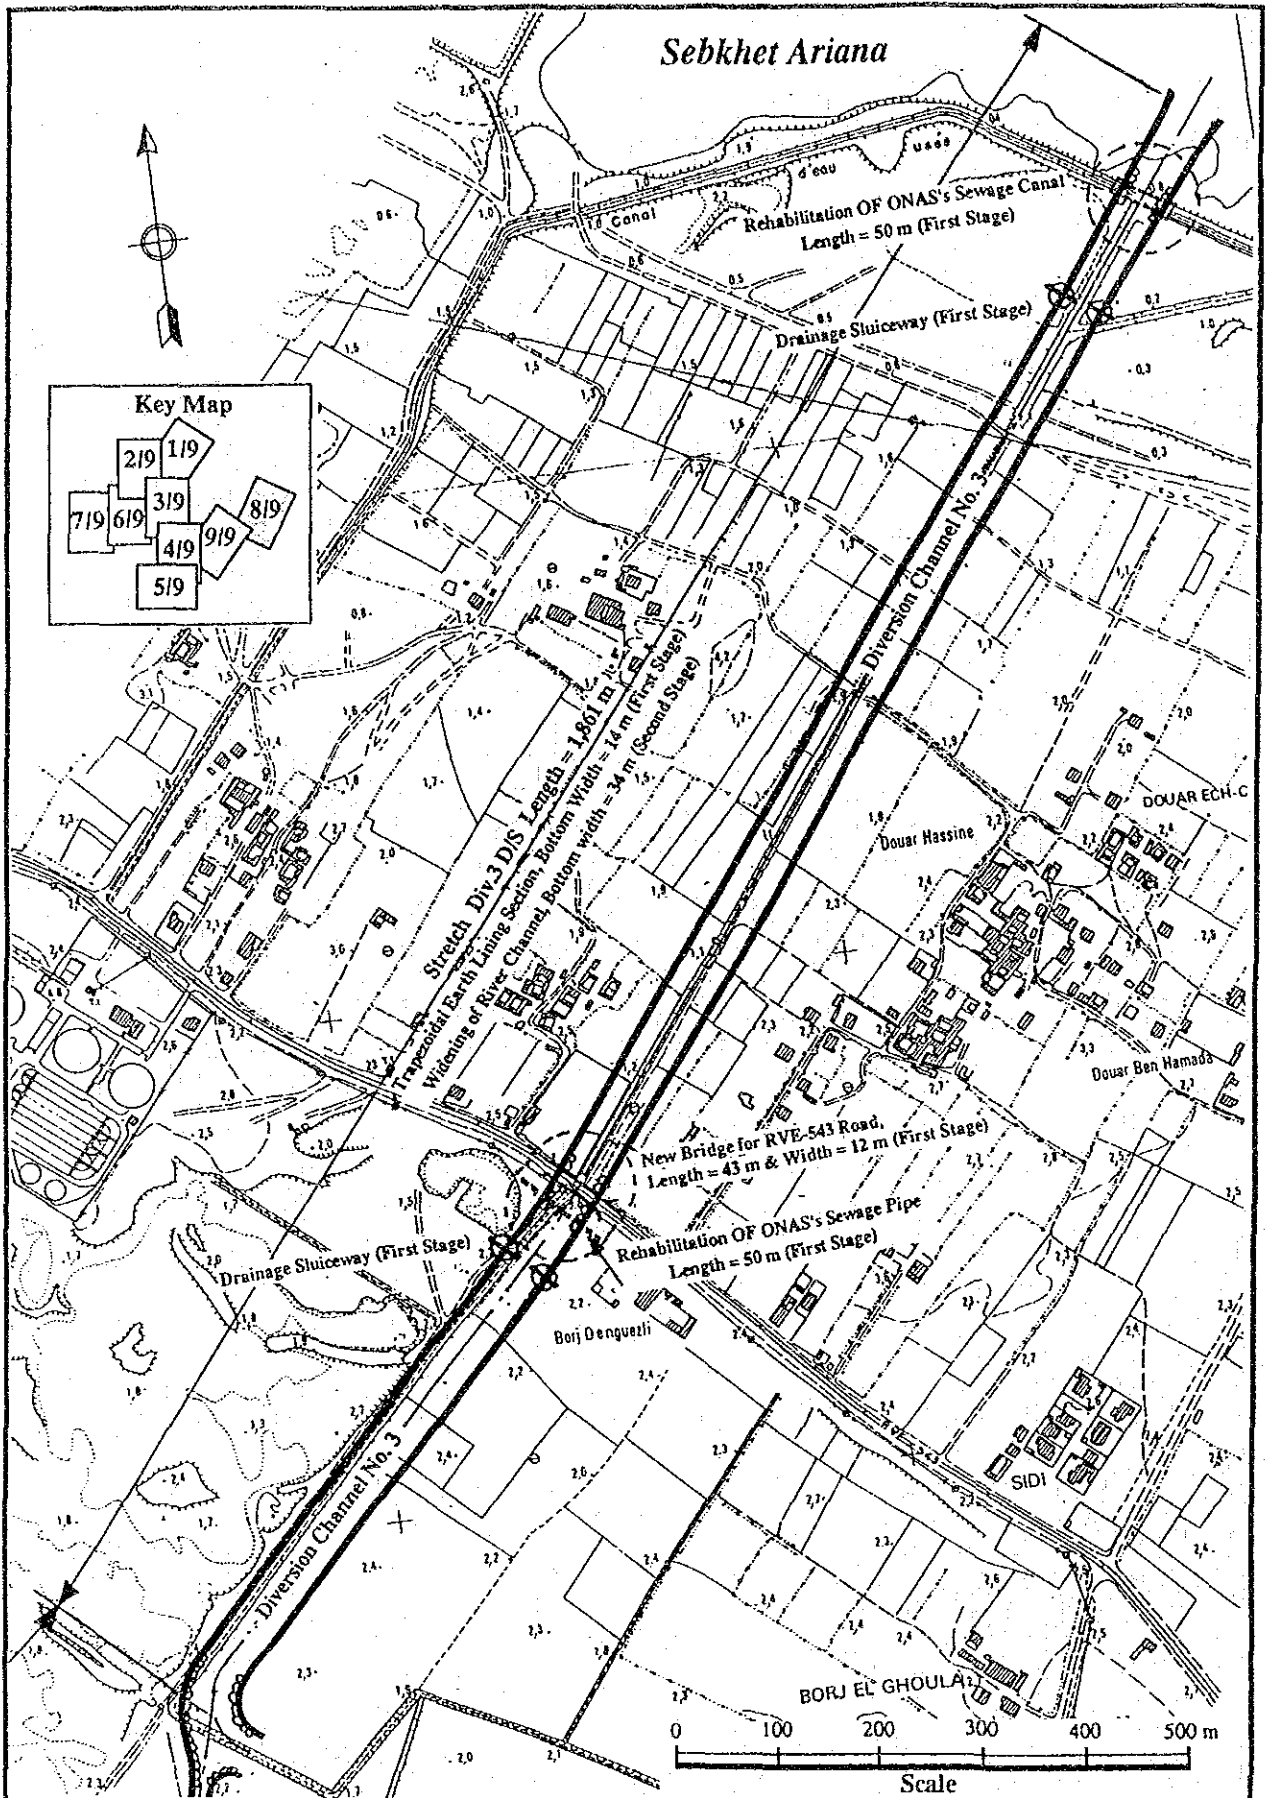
Tracé en plan de la variante d'aménagement de l'Oued Enkhilet (8/9)
